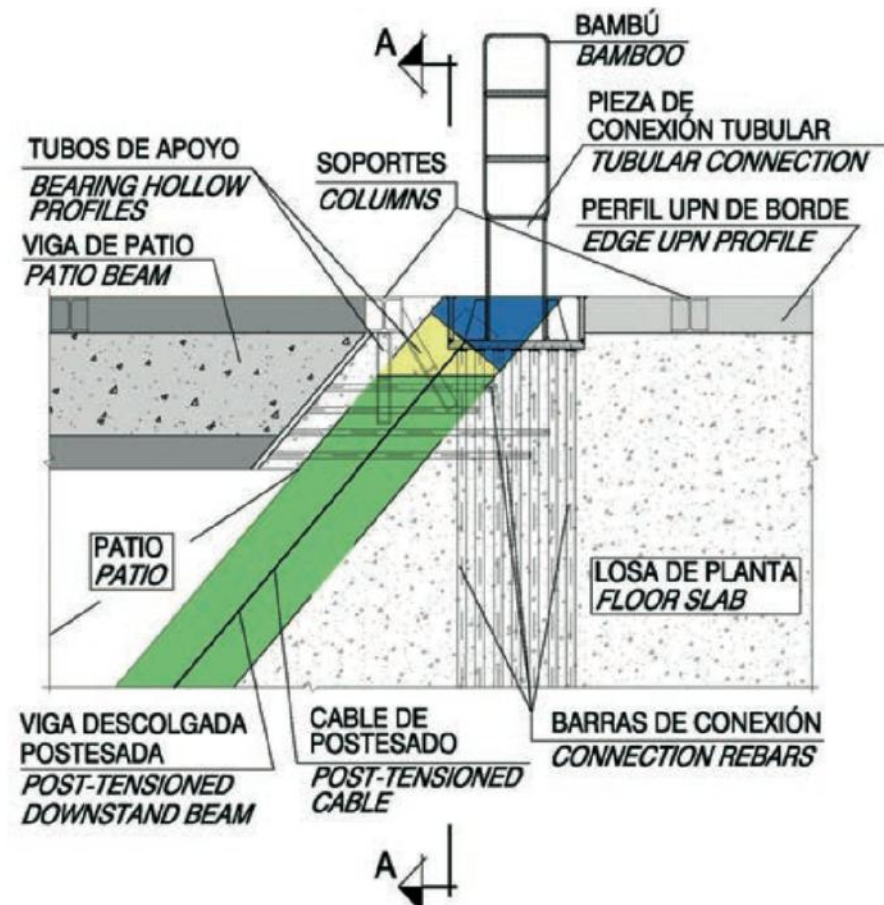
Planta encuentro de la viga de patio, viga descolgada y cajetín
